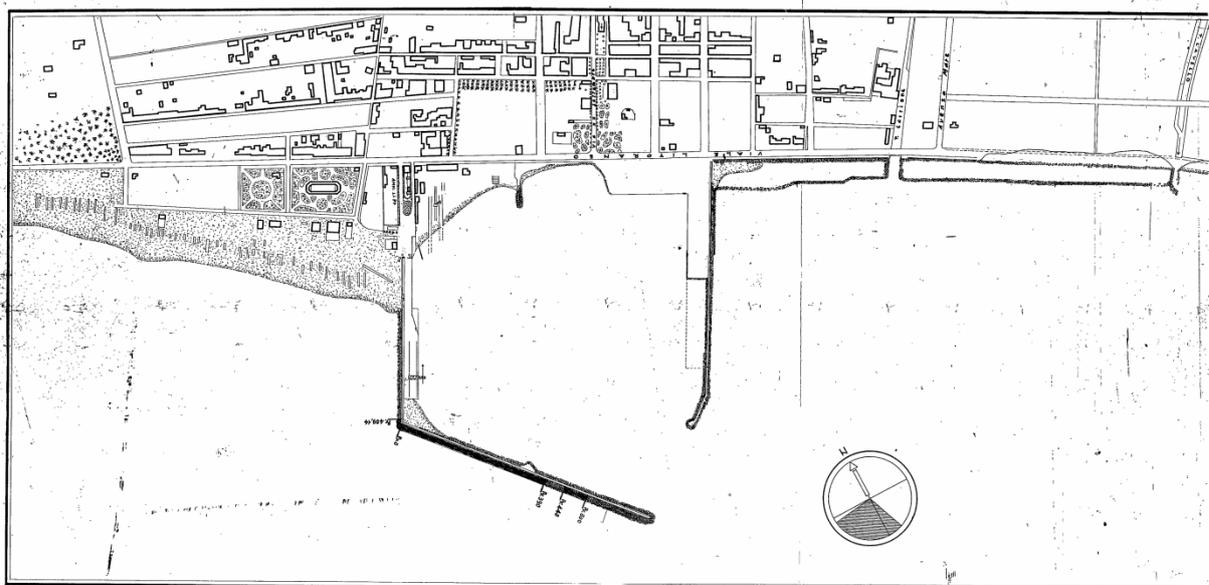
Planimetria del 1961 (fonte: Archivio OO.MM.)
